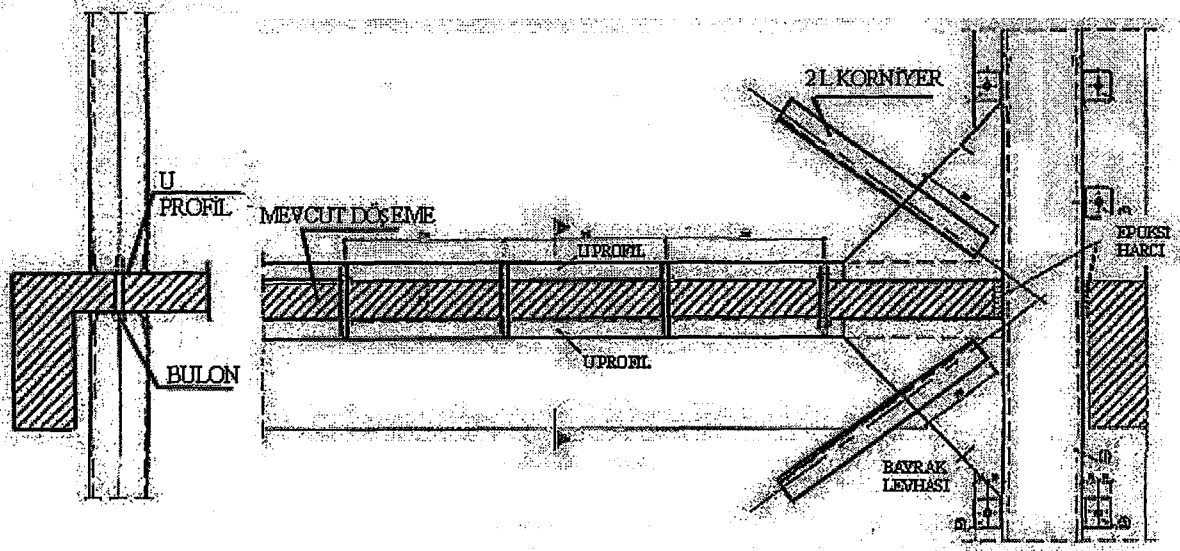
Kolon Kiriş ekseninde oluşturulan diyagonalin betonarme kiriş ile bağlantı detayı, (Kumbasar, 2000)
